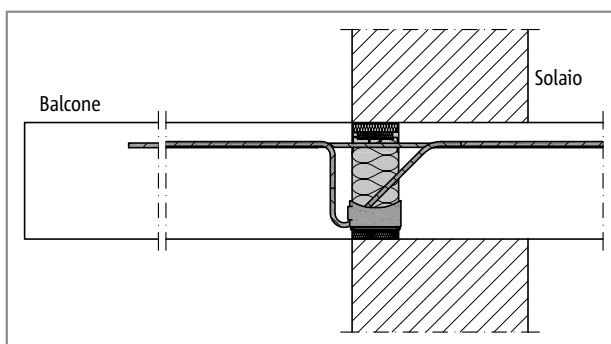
Schöck Isokorb® T tipo KL: muratura termoisolante monostrato con balcone alla medesima quota del solaio
